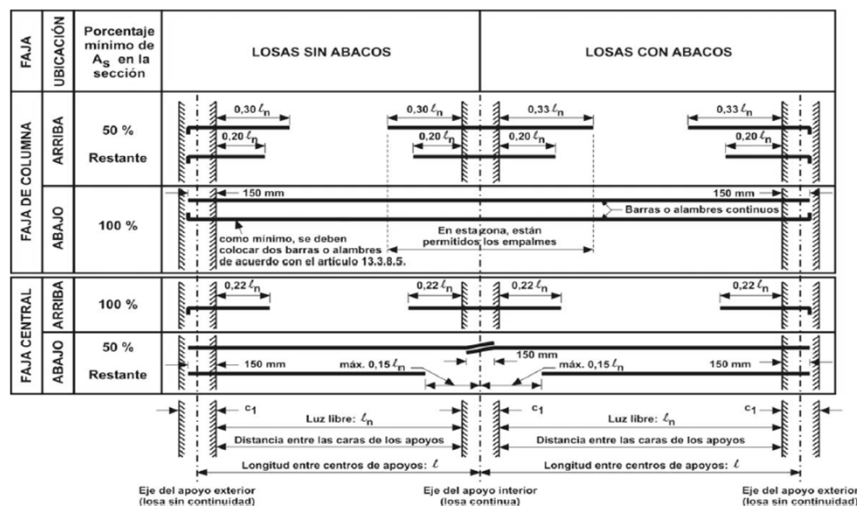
Prolongaciones mínimas para las armaduras en las losas sin vigas (ver el artículo 12.11.1. para la prolongación de las armaduras dentro de los apoyos).
